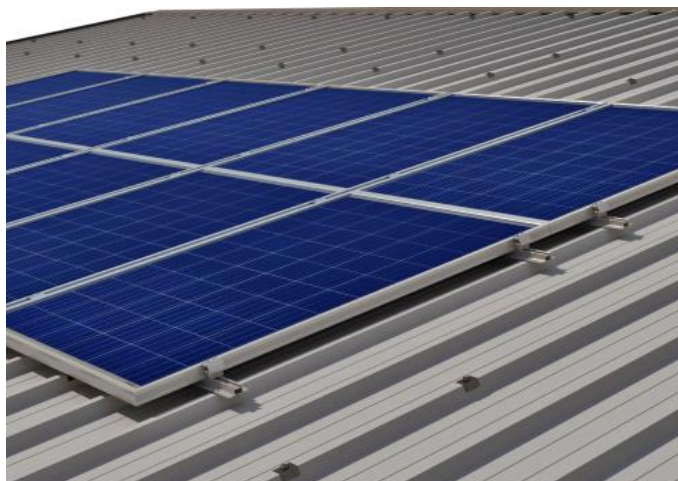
Modalità di installazione su tetto a falda (Foto dal web)
